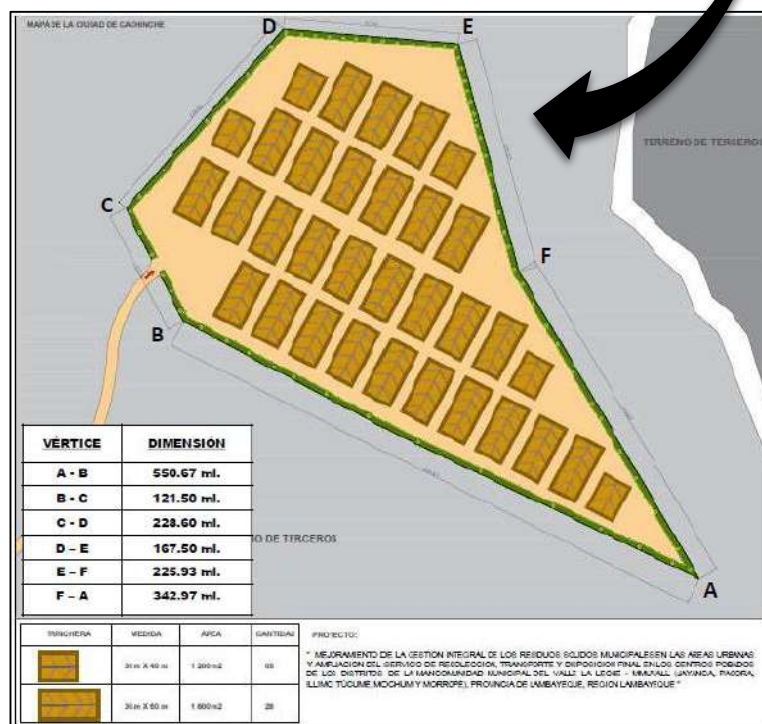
Dimensiones de terreno para relleno sanitario
